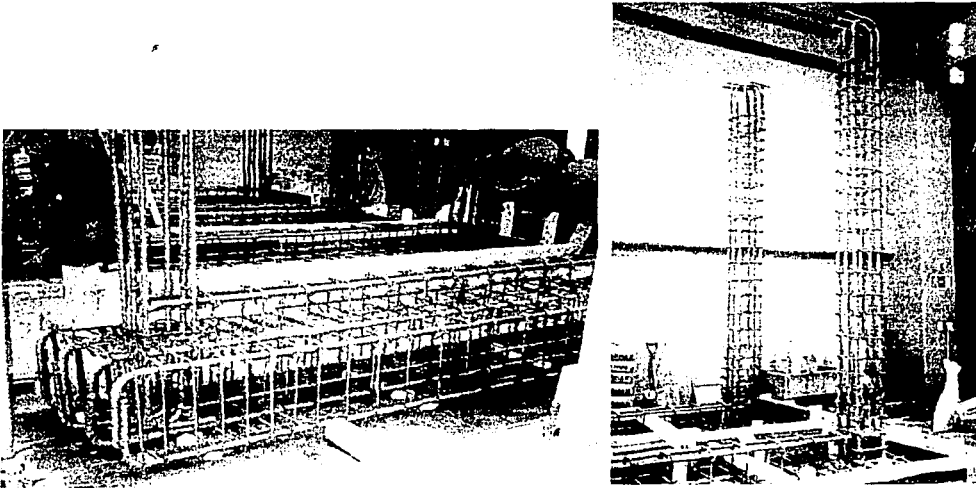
Armado de vigas de cimentación y de columnas del marco
